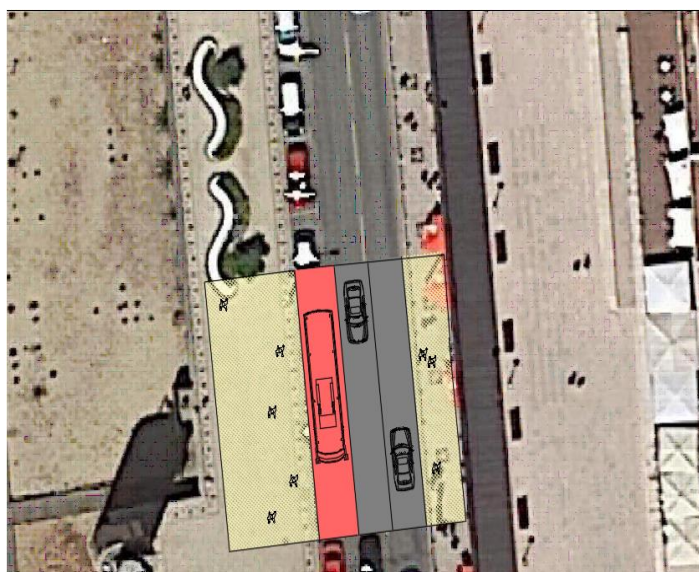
Proposta para reformulação da zona estreita Av. 25 de abril – trecho 3
